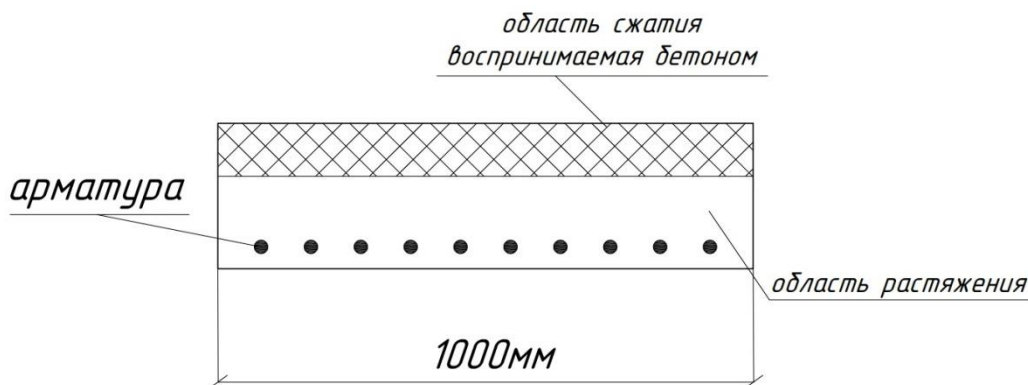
Поперечное сечение монолитной плиты перекрытия
